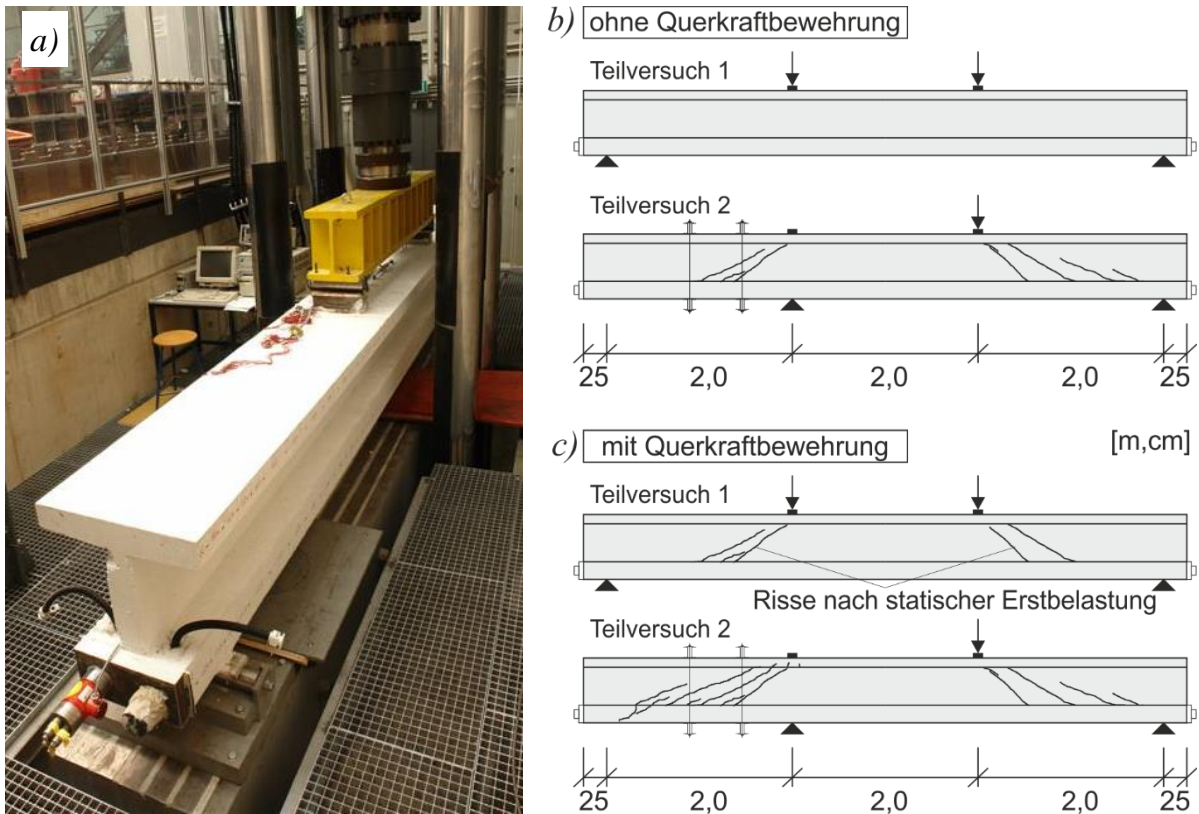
Versuchsdurchführung: a) Träger in Versuchsstand; b) Träger ohne Querkraftbewehrung; c) Träger mit Querkraftbewehrung
